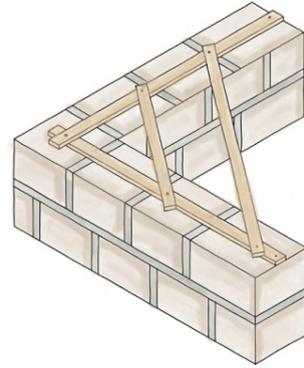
Refuerzo en esquinas de muros de adobe, Autoría propia, 2024
